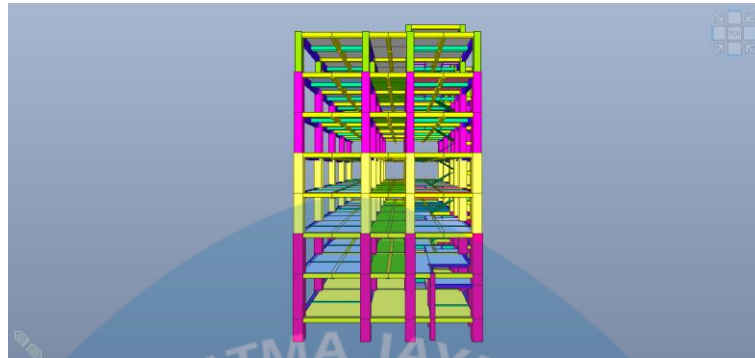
Tampak Utara Pemodelan 3D Bangunan Utama
